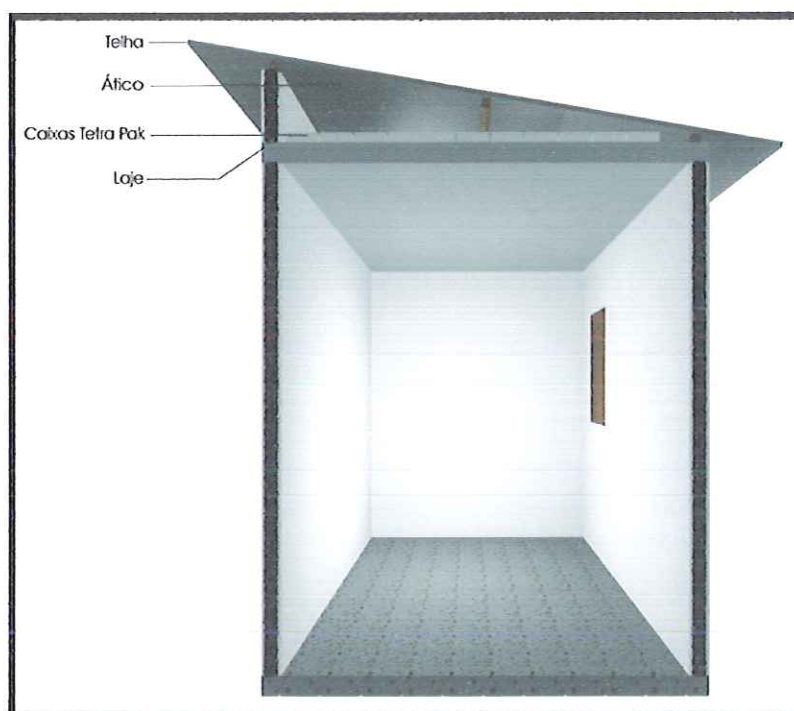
colocação das caixas Tetra Pak uma ao lado da outra, sobre a laje do protótipo 02. dentro do ático
